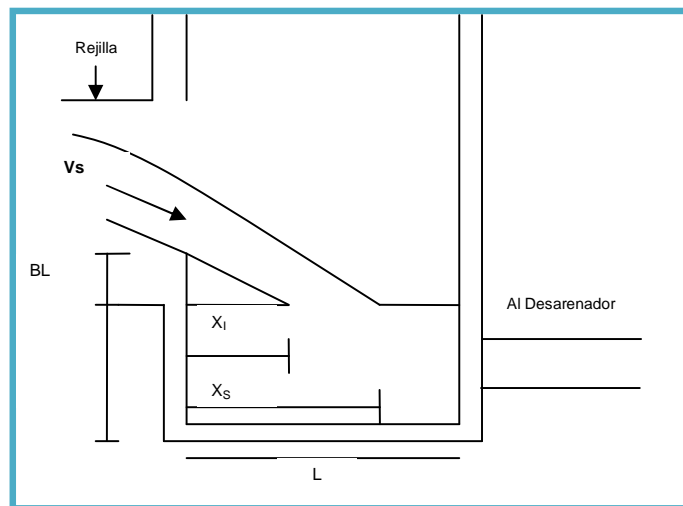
Corte de la cámara de recolección (López Cualla)¹²
